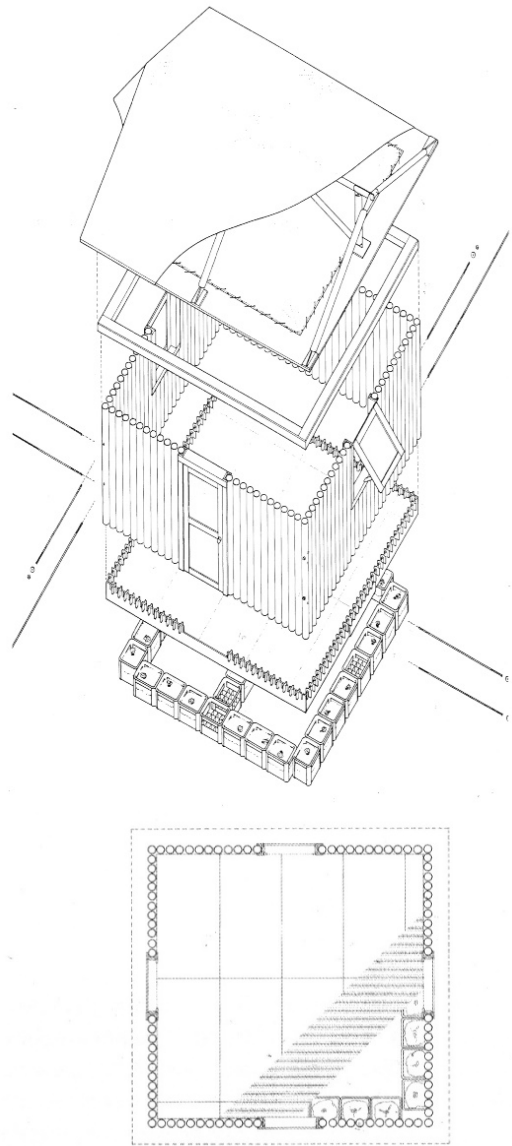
Axonometría, planta y sección de la Casa de troncos de papel de Japón
